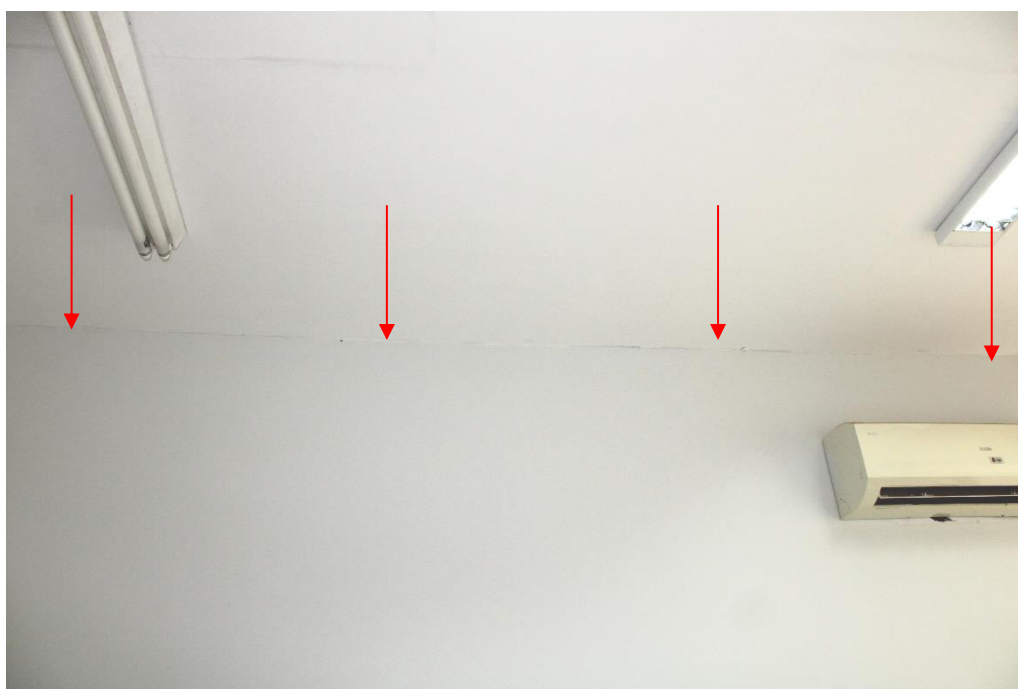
Vista parcial da sala 49, destacando fissura em laje de teto.
